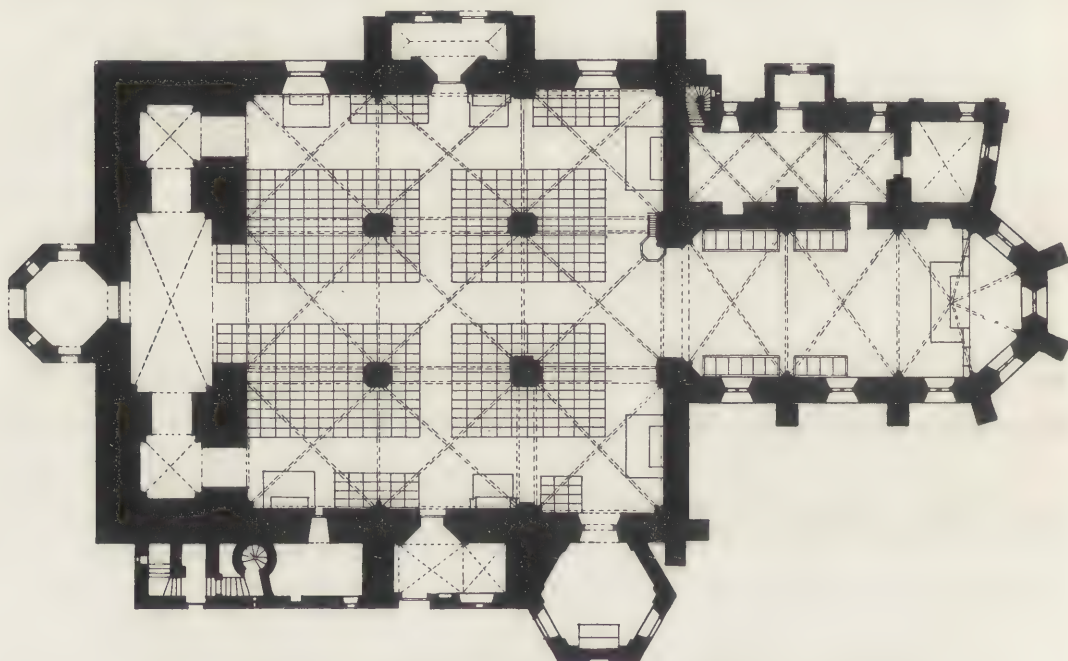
Grundriss der katholischen Stadtpfarrkirche zu Leobschütz vor dem Umbau.
